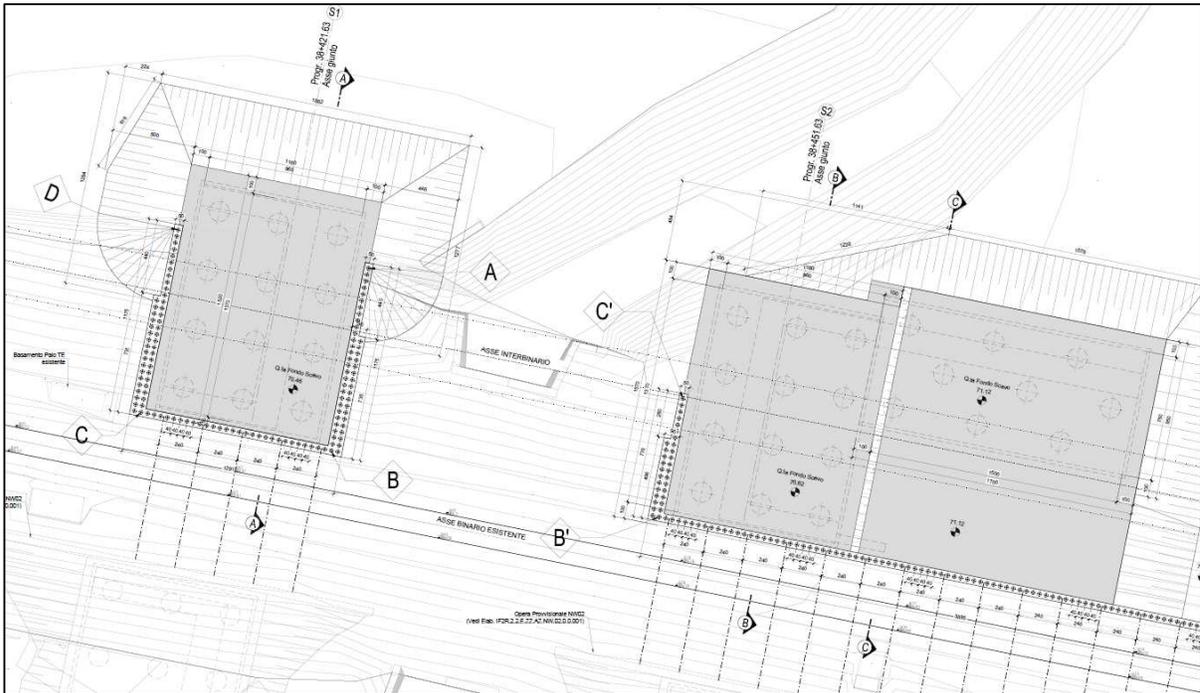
Inquadramento planimetrico lato ferrovia
